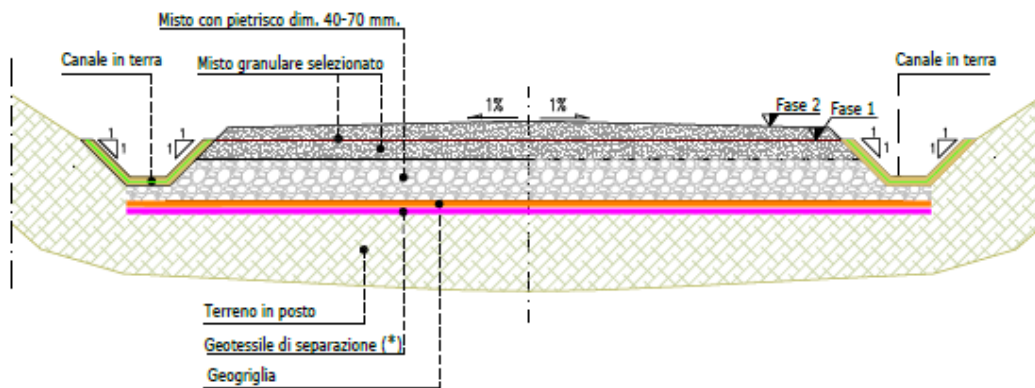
Sezione stradale tratti in trincea ($p < 13\%$)
